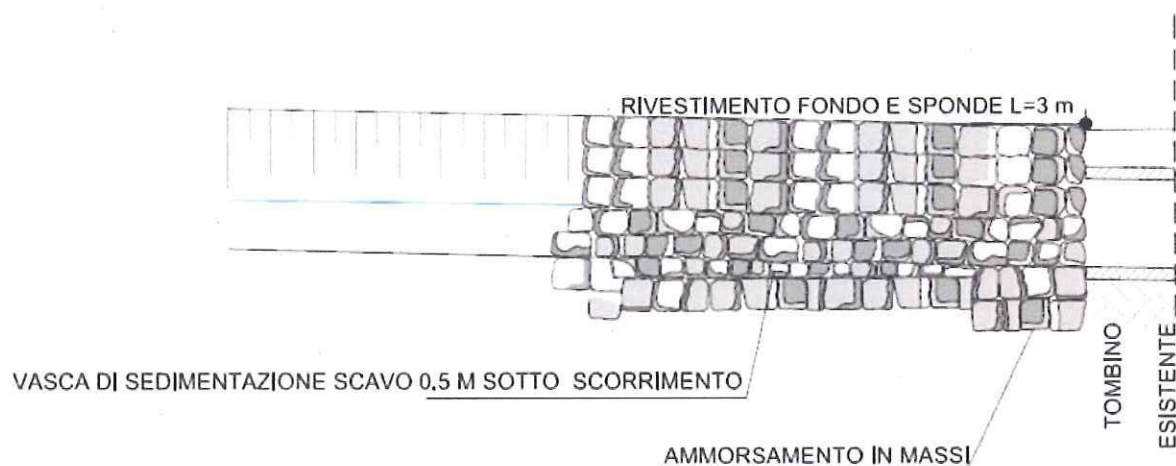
Profilo longitudinale vasca di sedimentazione in calcestruzzo rivestita in pietrame.
